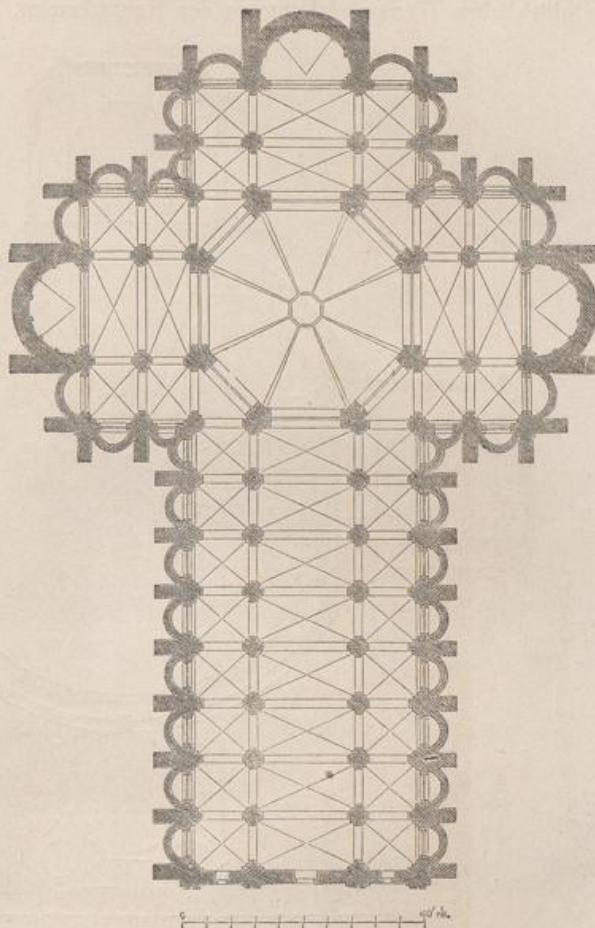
Dom zu Pavia. Grundriss.
